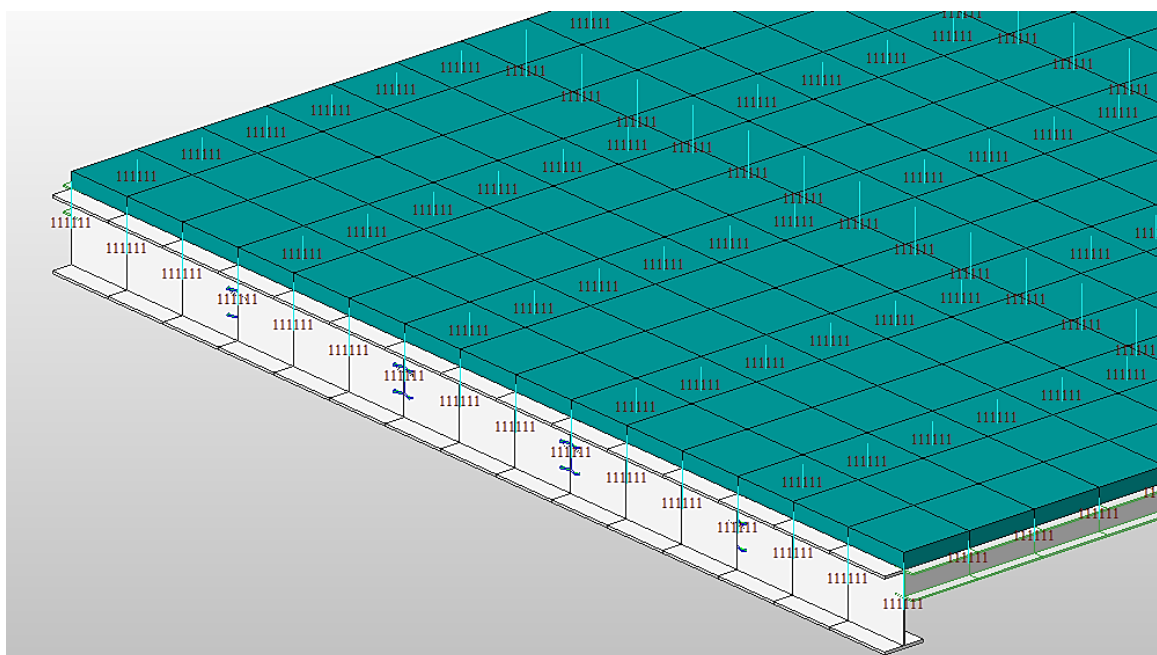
Ligação da laje de betão armado aos elementos metálicos
